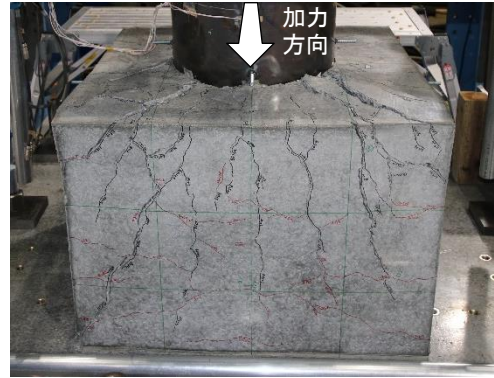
試験体 No. 1 前面の破壊状況 ($R = +10\%$ 時)
